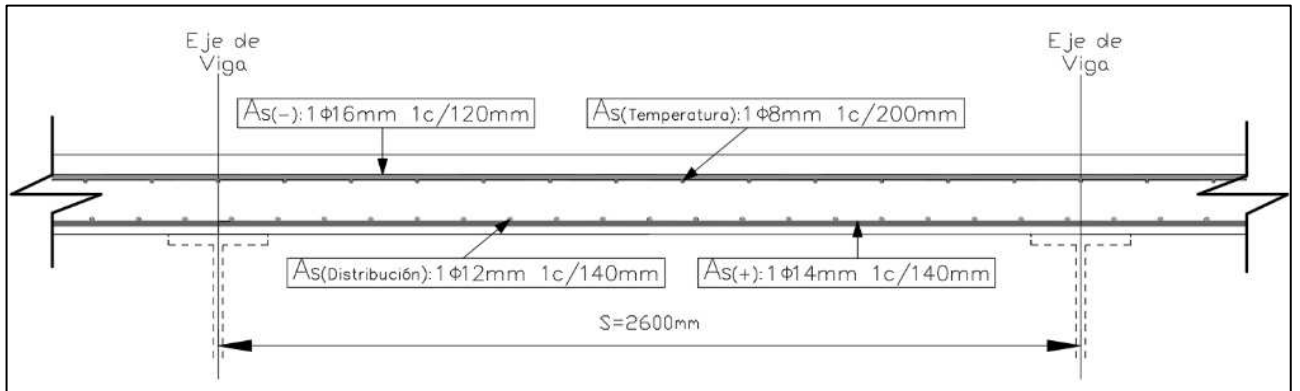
Armado del Tramo BC entre vigas del Tablero.
